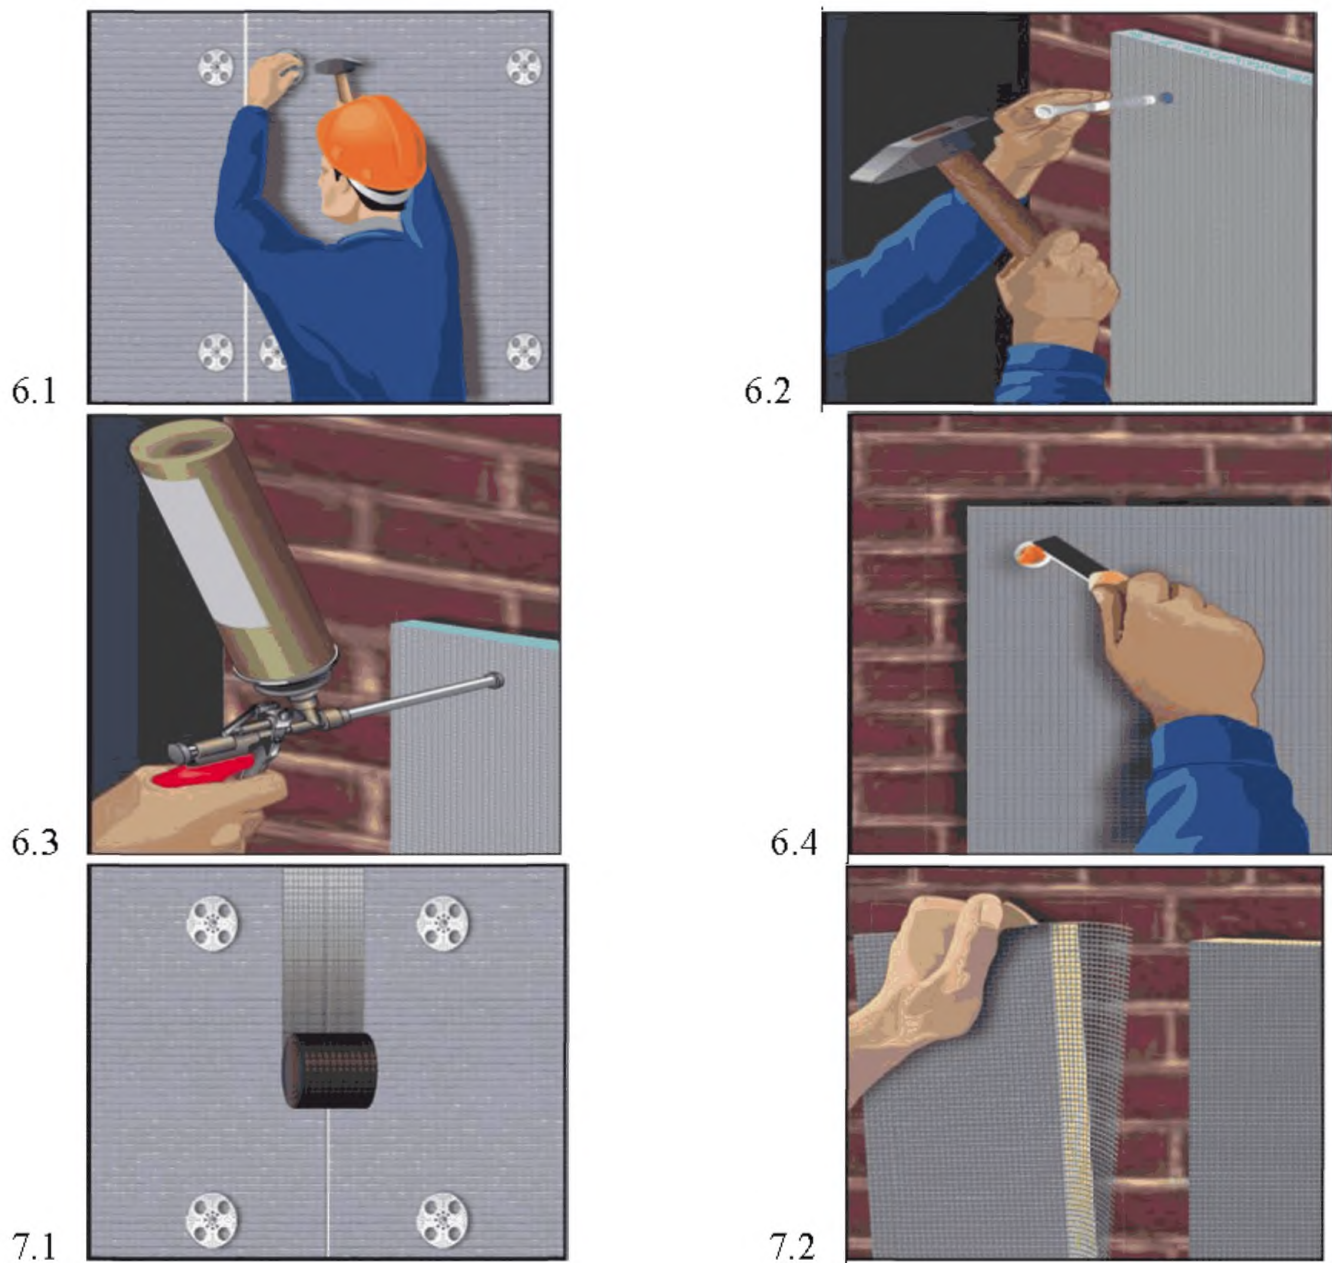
Последовательность крепления панели БАРЛАЙТ к наружной и внутренней поверхностям наружных стен
